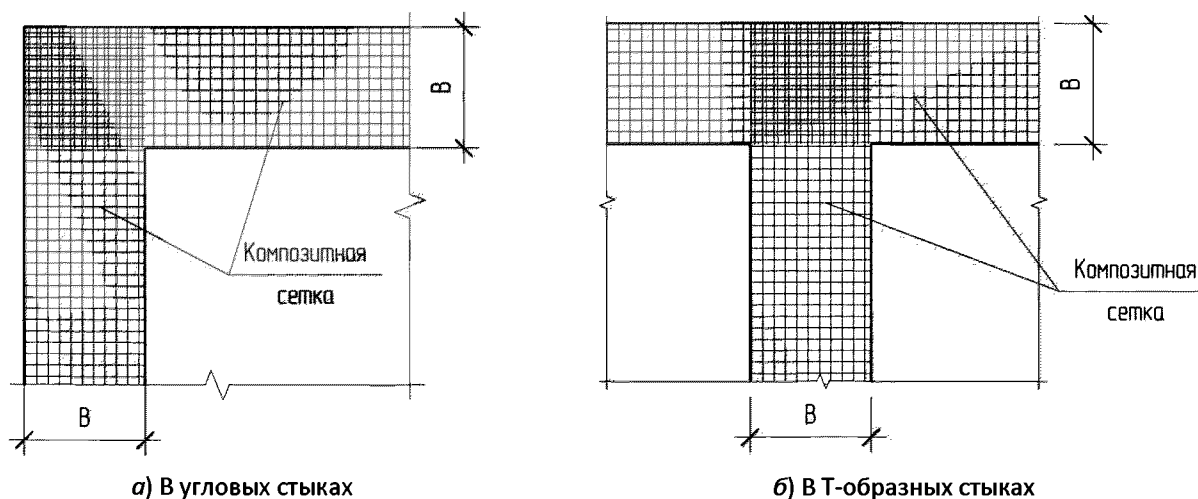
Пример раскладки арматурных сеток на пересечении стен
